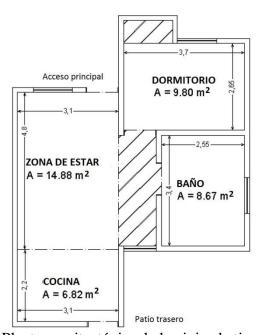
Planta arquitectónica de la vivienda tipo estudiada.
